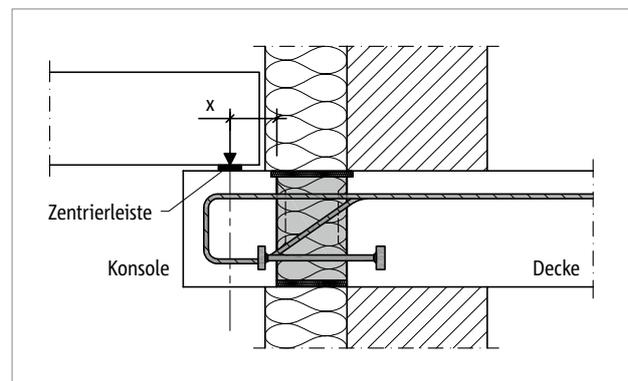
Schöck Isokorb® XT Typ O: Anschluss einer Konsole als Deckenaufleger; Zentrierleisten verhindern eine Verschiebung des Lasteinleitungspunktes
